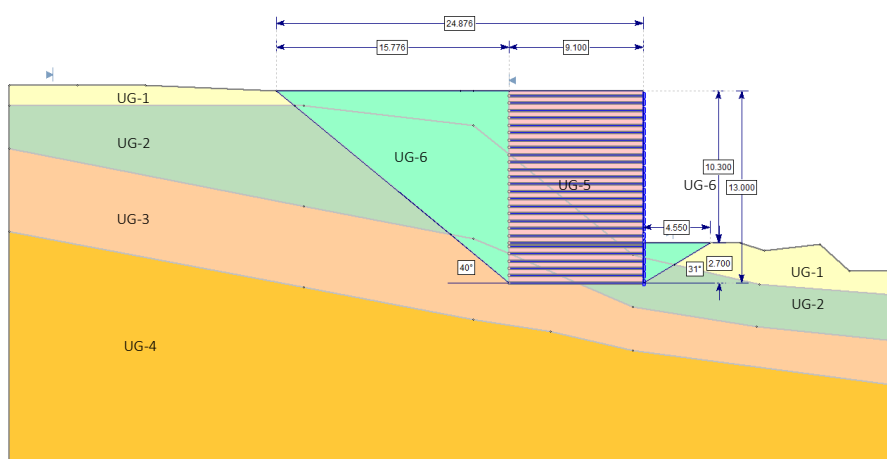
Geometría propuesta del muro de suelo reforzado.
